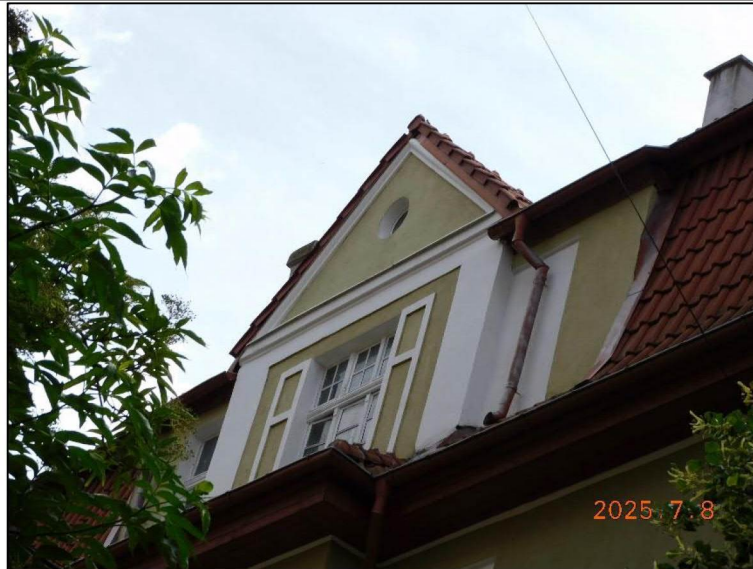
Оконные проемы на фронтовых стенах мансарды на фасадах № 2, № 8.
